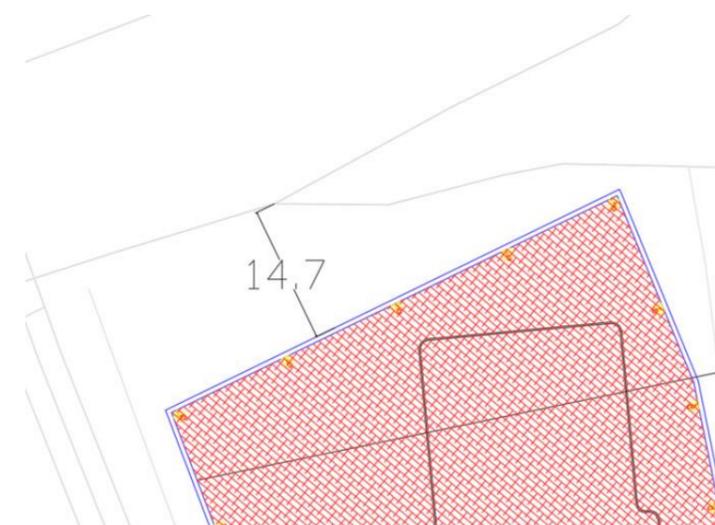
Stralcio Planimetrico – distanza minima incisione-piazzale di progetto
